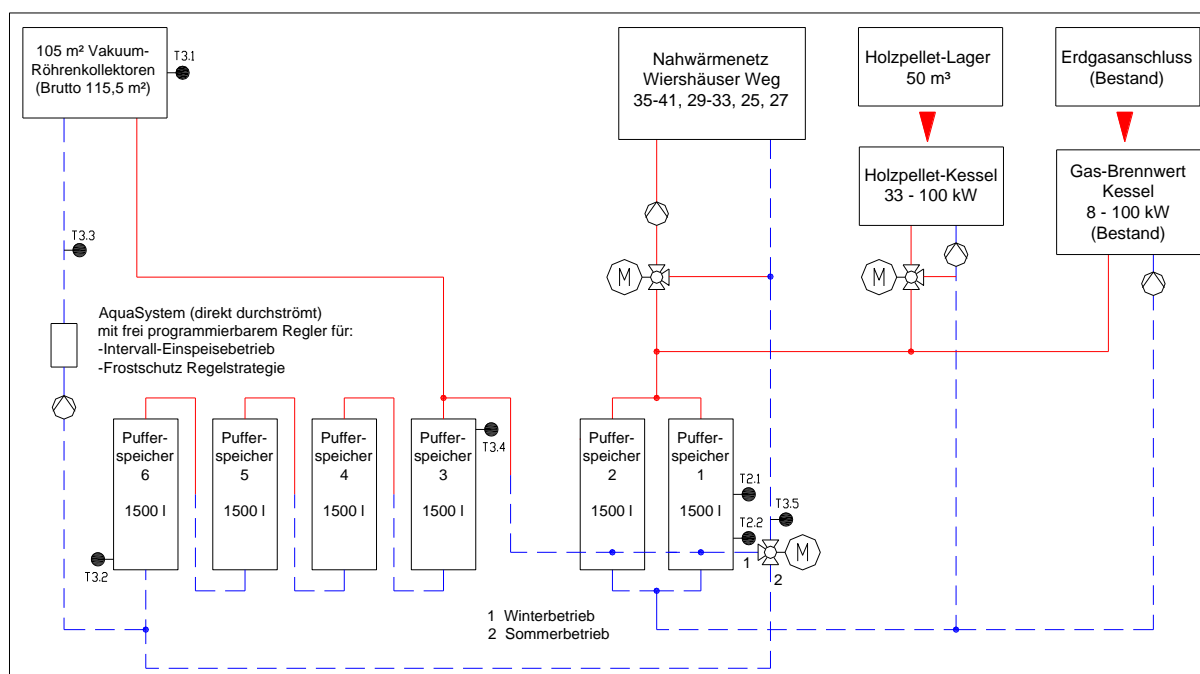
Vereinfachtes Hydraulikschema Anlage Hannoversch Münden, Wiershäuser Weg
